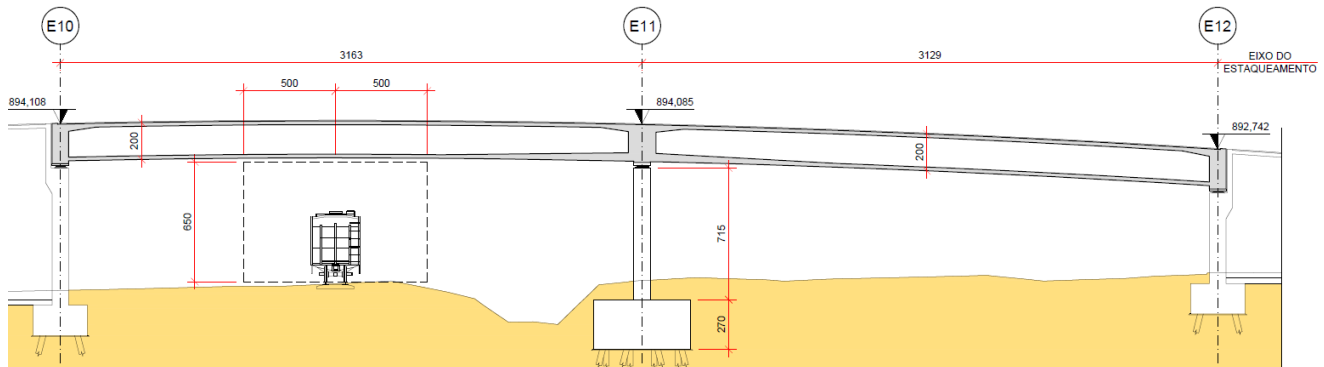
ELEVÇÃO VIADUTO (RAMO 300)
